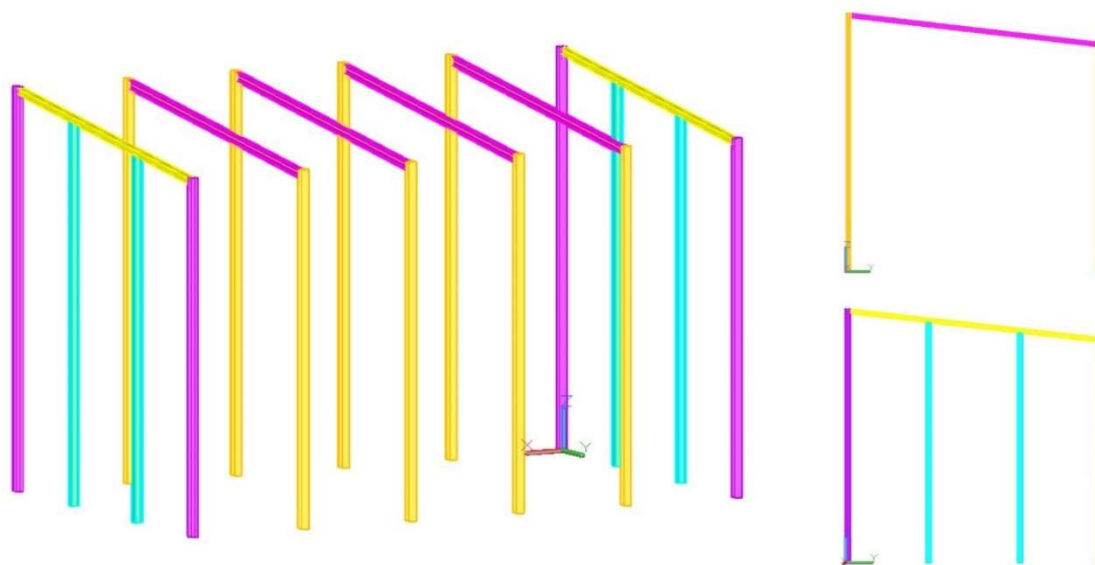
Modelo 3D - Implantação de pilares e travessas
